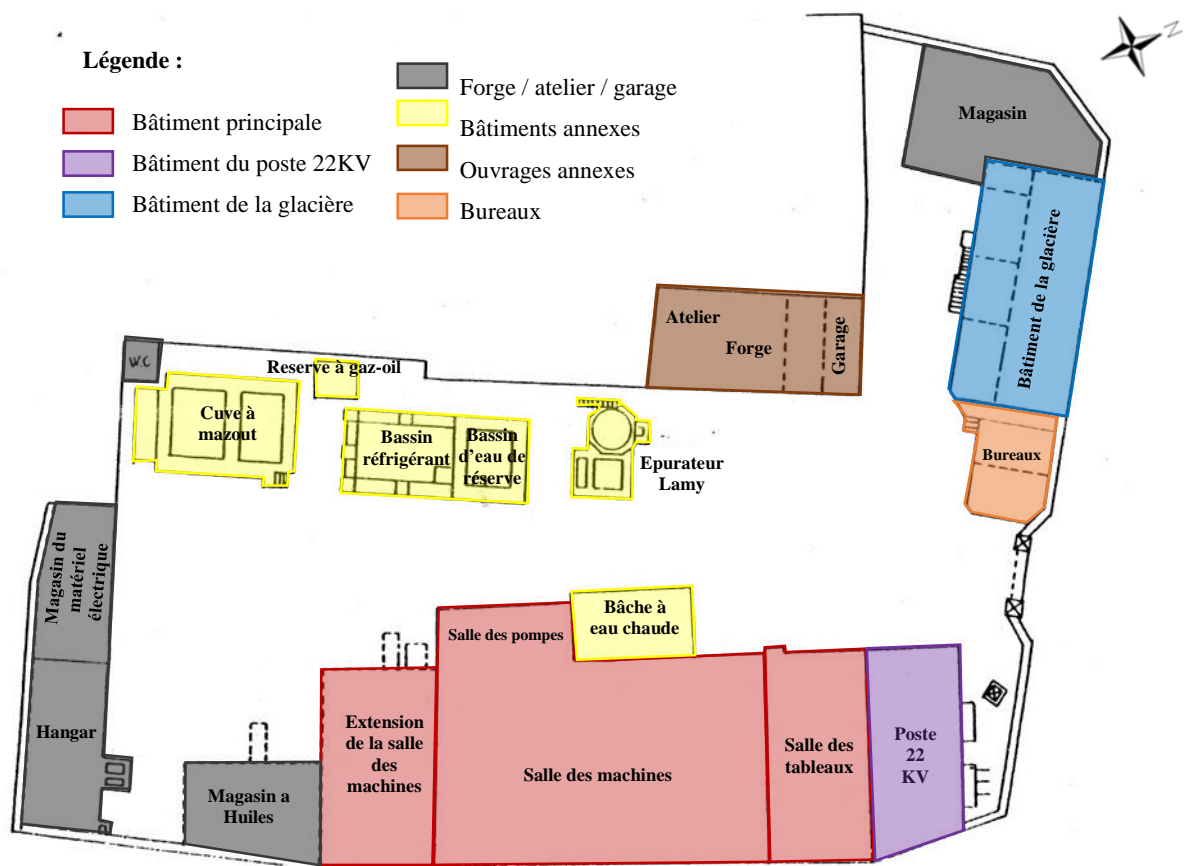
Plan de masse de la centrale Diesel de Laghouat, 1/300
